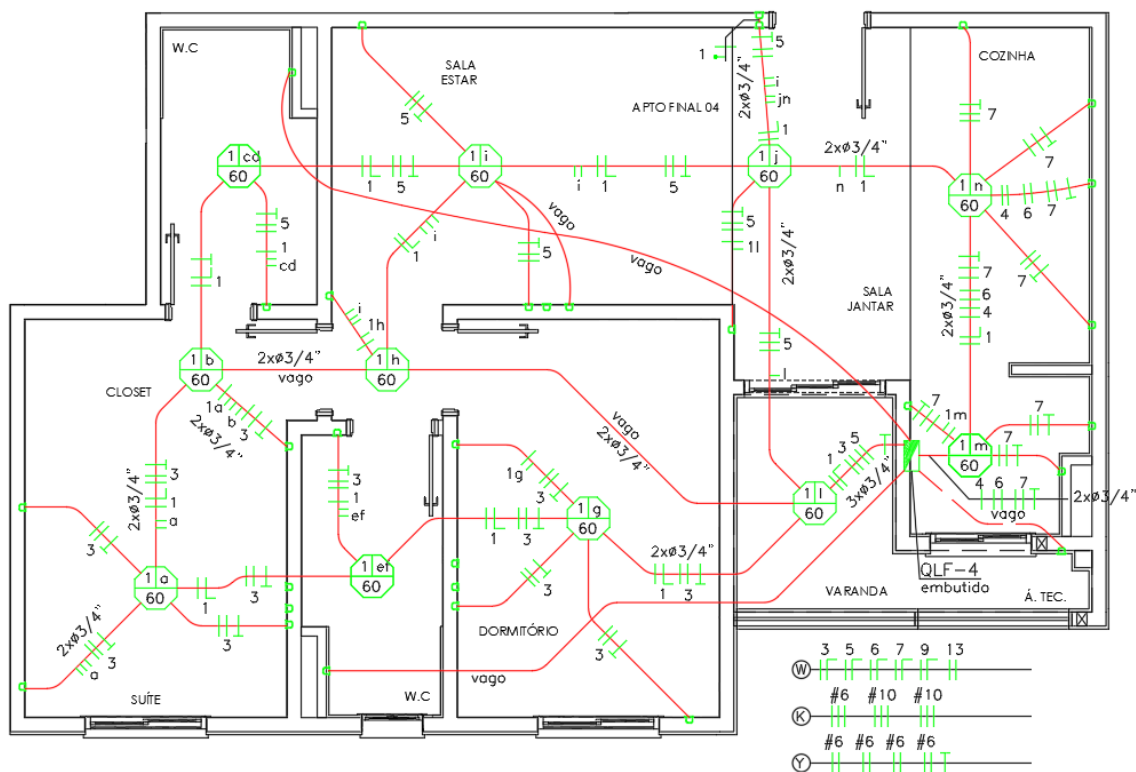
Projeto da infraestrutura de elétrica do apartamento de 68m² do empreendimento Altos da Avenida, Construtora Santa Angela, Jundiaí, São Paulo (Fonte: Aurea Projetos, 2020).
